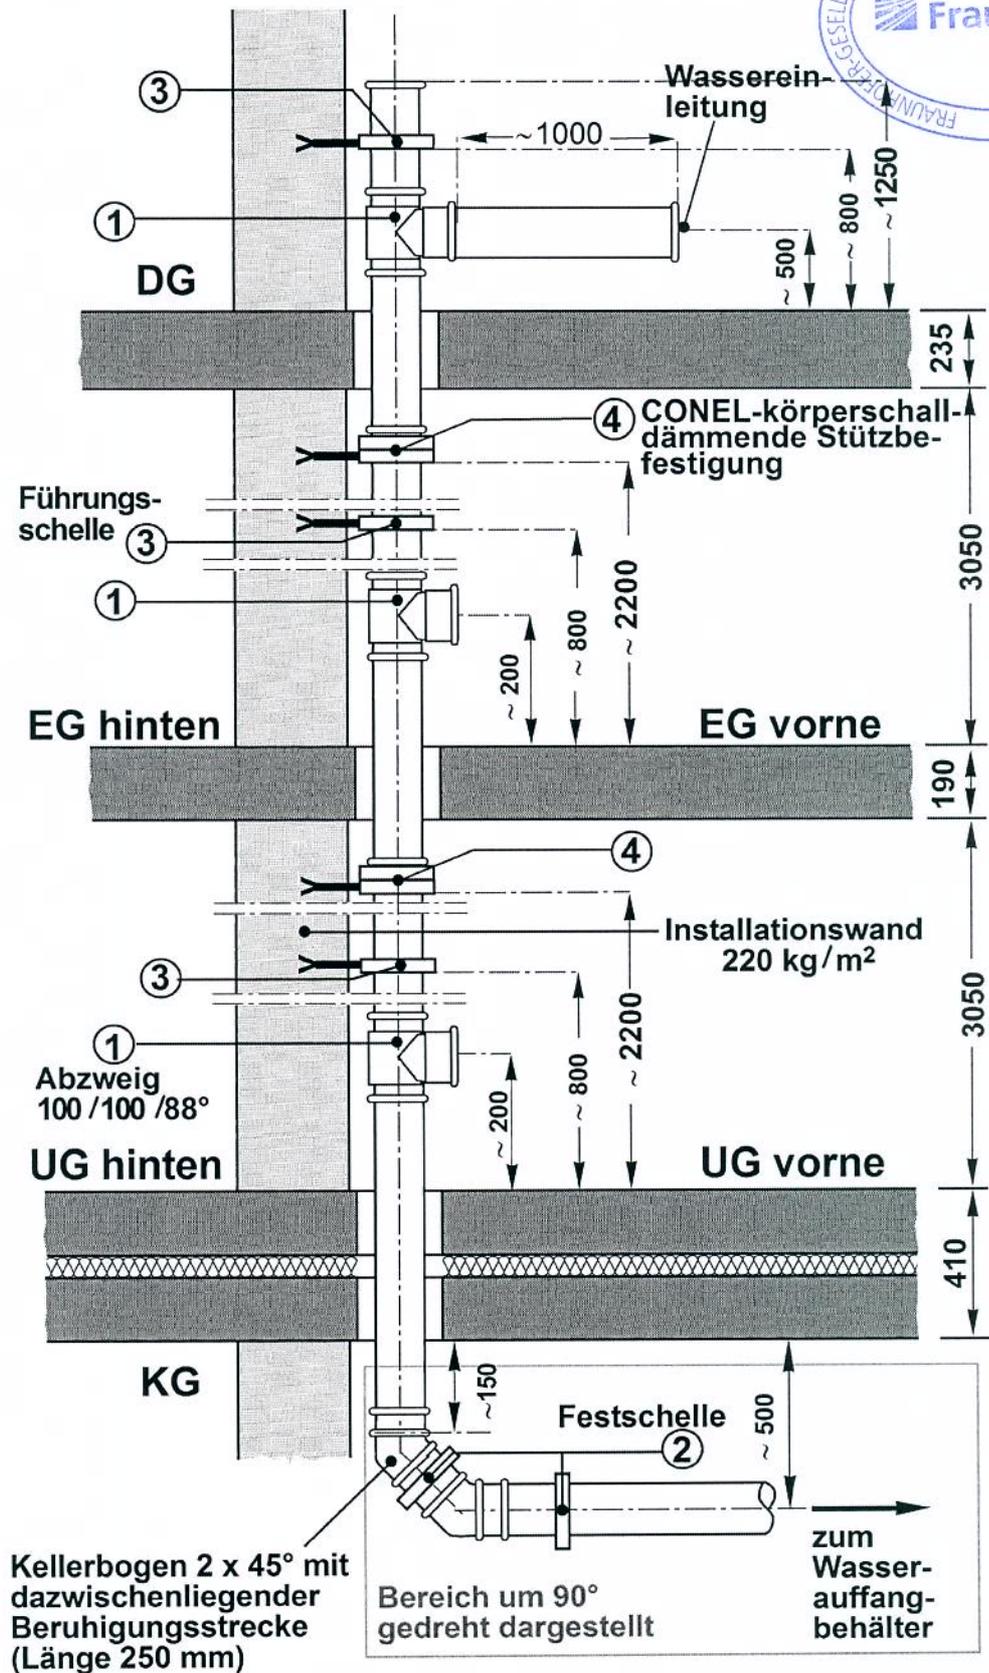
Installationsplan für das Abwassersystem "Schalldämmendes Hausabflußrohr-System CONEL DRAIN" der Firma CONEL mit dem dazugehörigen Befestigungssystem "körperschalldämmende Stützbe- festigung" (Darstellung nicht maßstäblich, Maßangaben in mm).
